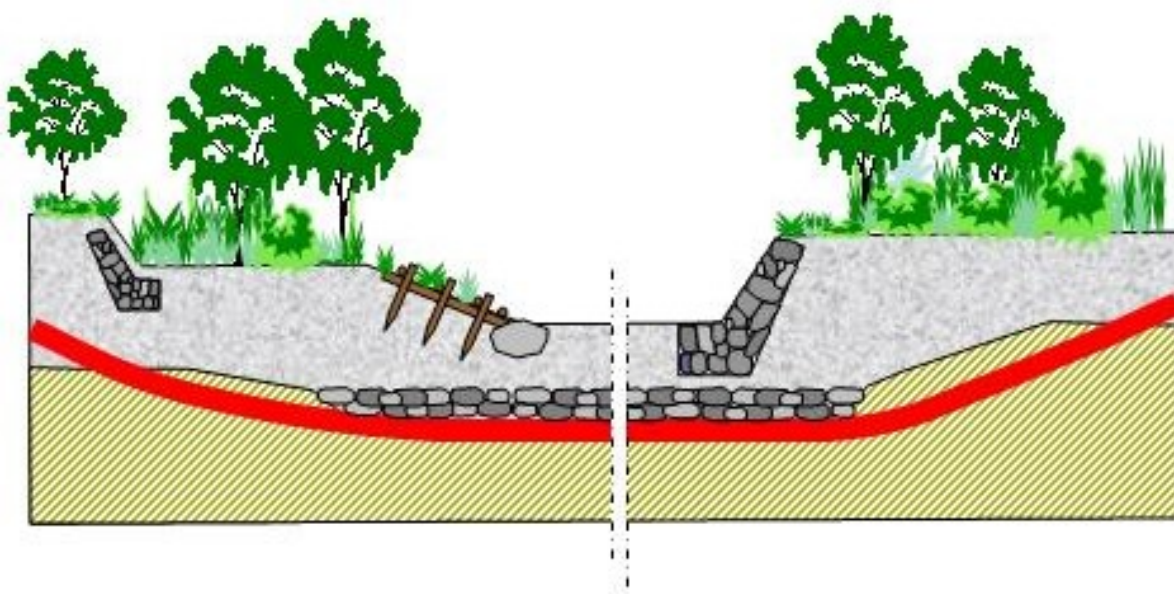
/B: Sezione schematica dell'attraversamento del F. Savio
